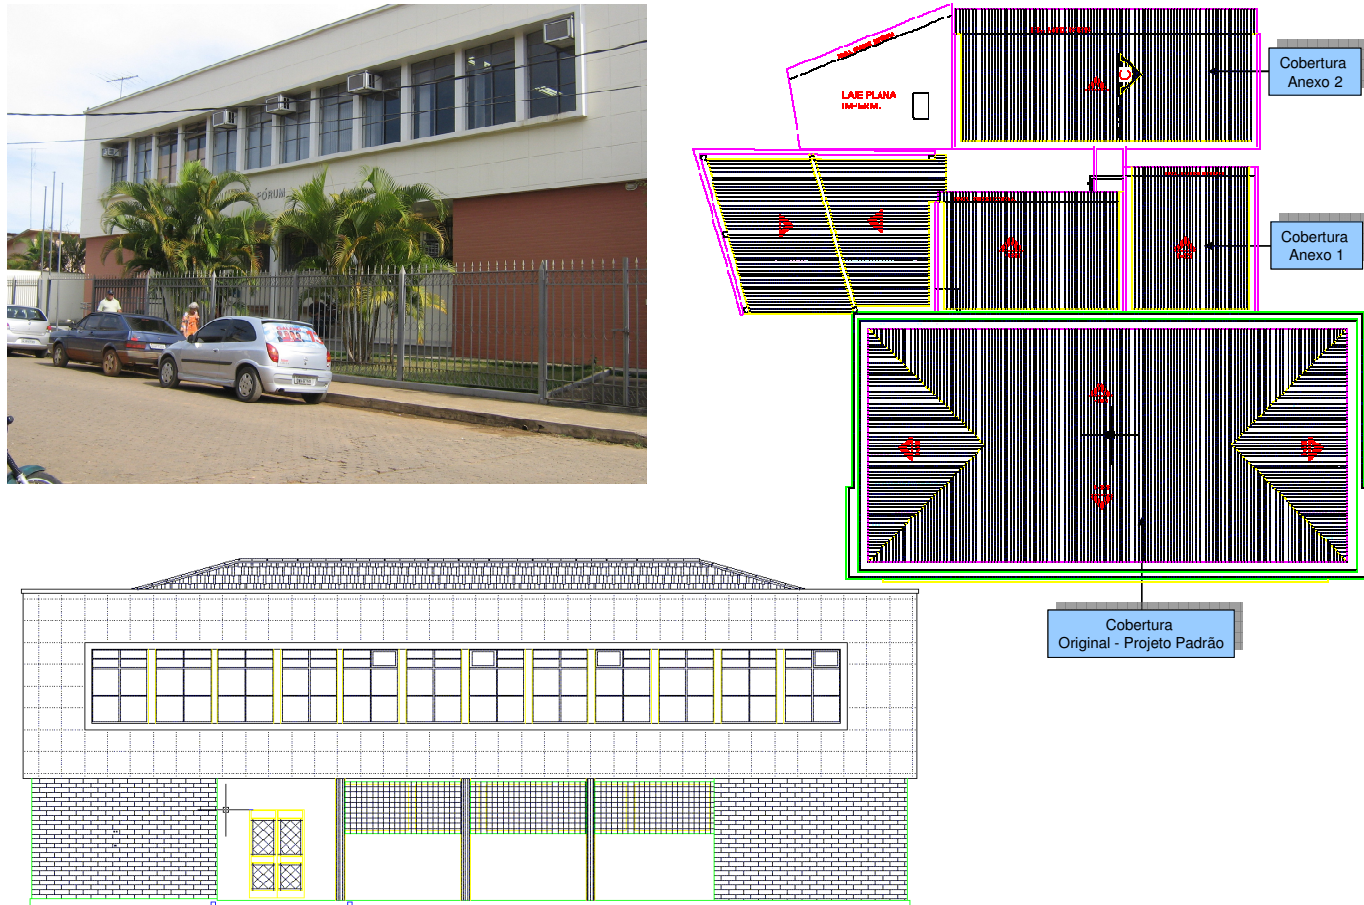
Detalhe da fachada e da planta de cobertura.
